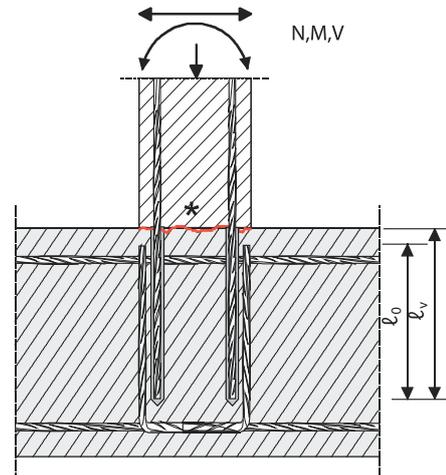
Ancrage direct d'armatures en extrémité de dalles ou poutres, simplement appuyé.
